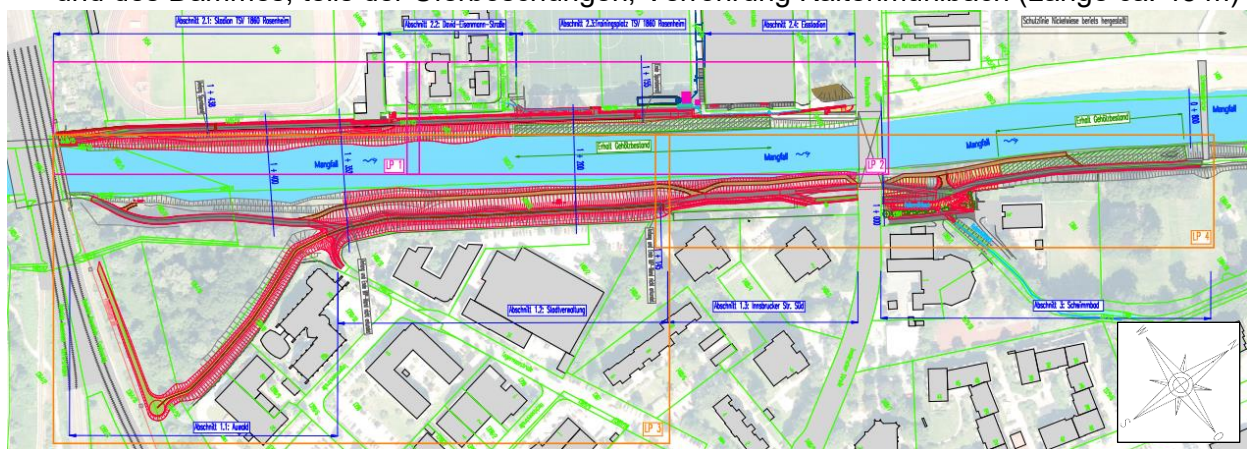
Übersicht der Bauabschnitte mit Darstellung der Planung (Quelle: aquasoli 2025, Lageplan Anlage 2.2)
